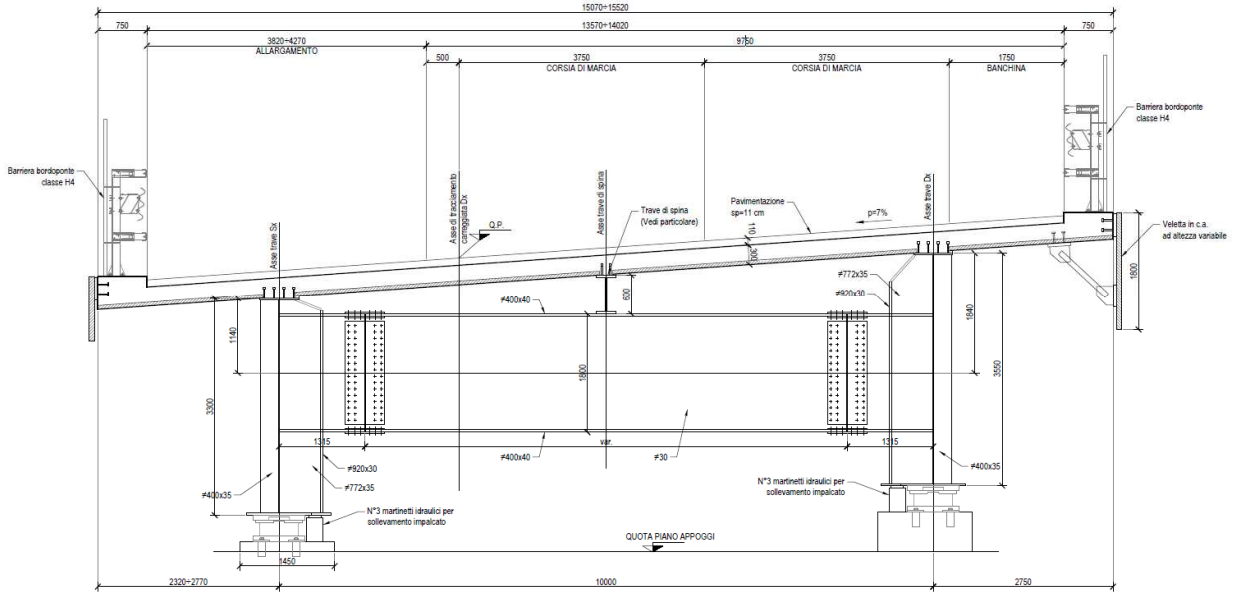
Sezione trasversale dell'impalcato carreggiata sinistra
